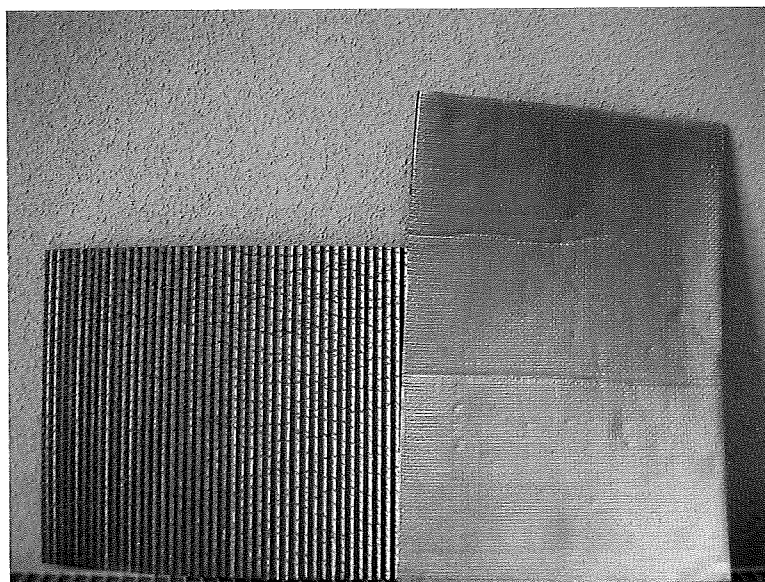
Detalle de las caras interior y exterior de la lámina vista, con las acanaladuras y el refuerzo de aluminio.
